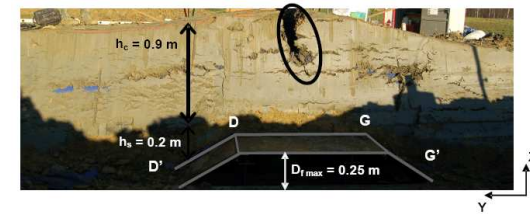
Coupe verticale de la planche T3 à la fin de l'essai d'après Camp (2008).
